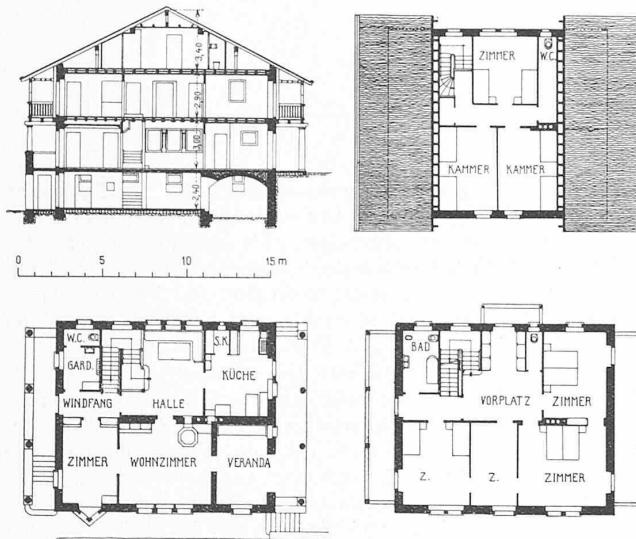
bis 4. Haus Dr. Misslin in Flims. Grundrisse und Schnitt 1 : 400.
